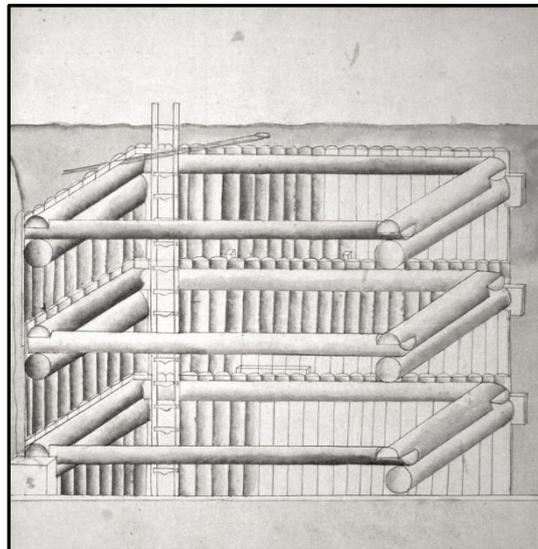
Plano de la sección de enmaderado de un pozo de mina
